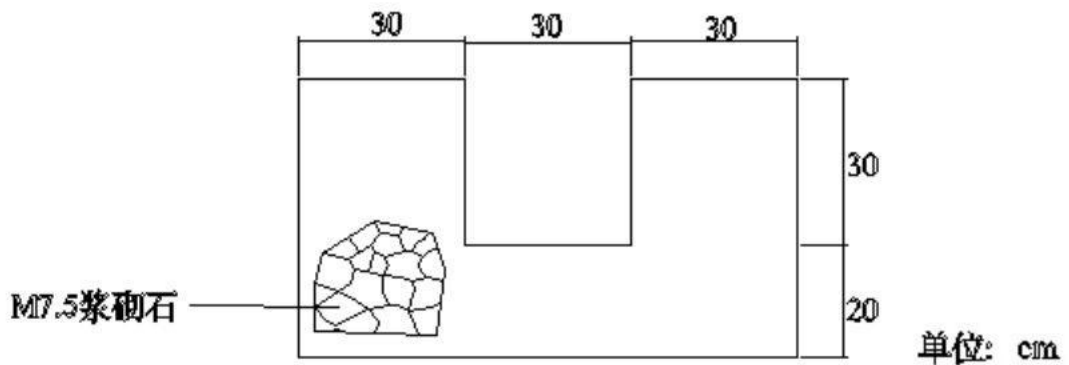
工业场地截排水沟（5、6 号排水沟）断面图
